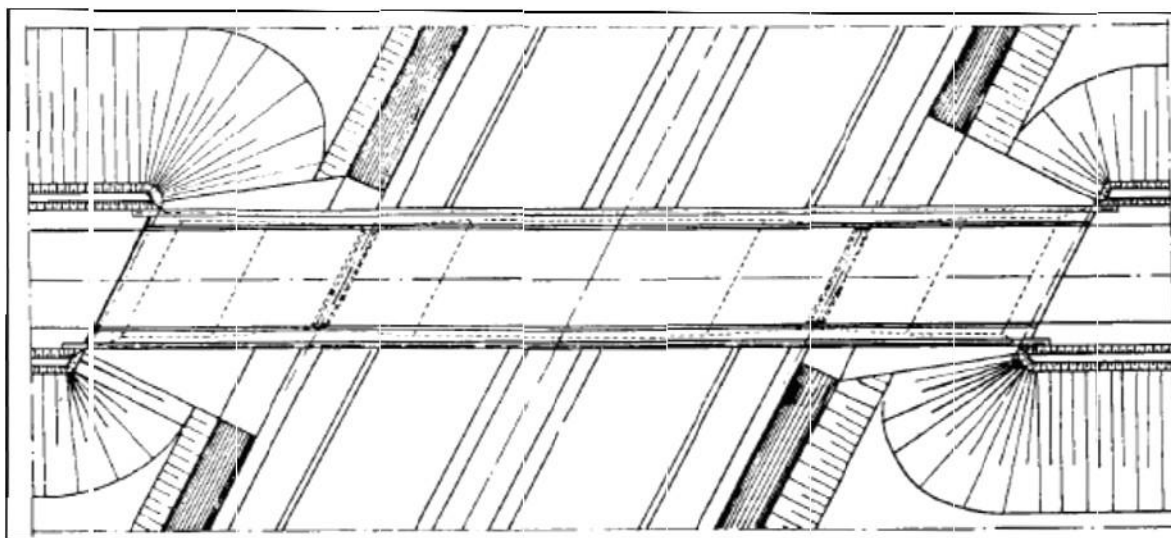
Vue en plan d'un pont dalle en précontraint.
